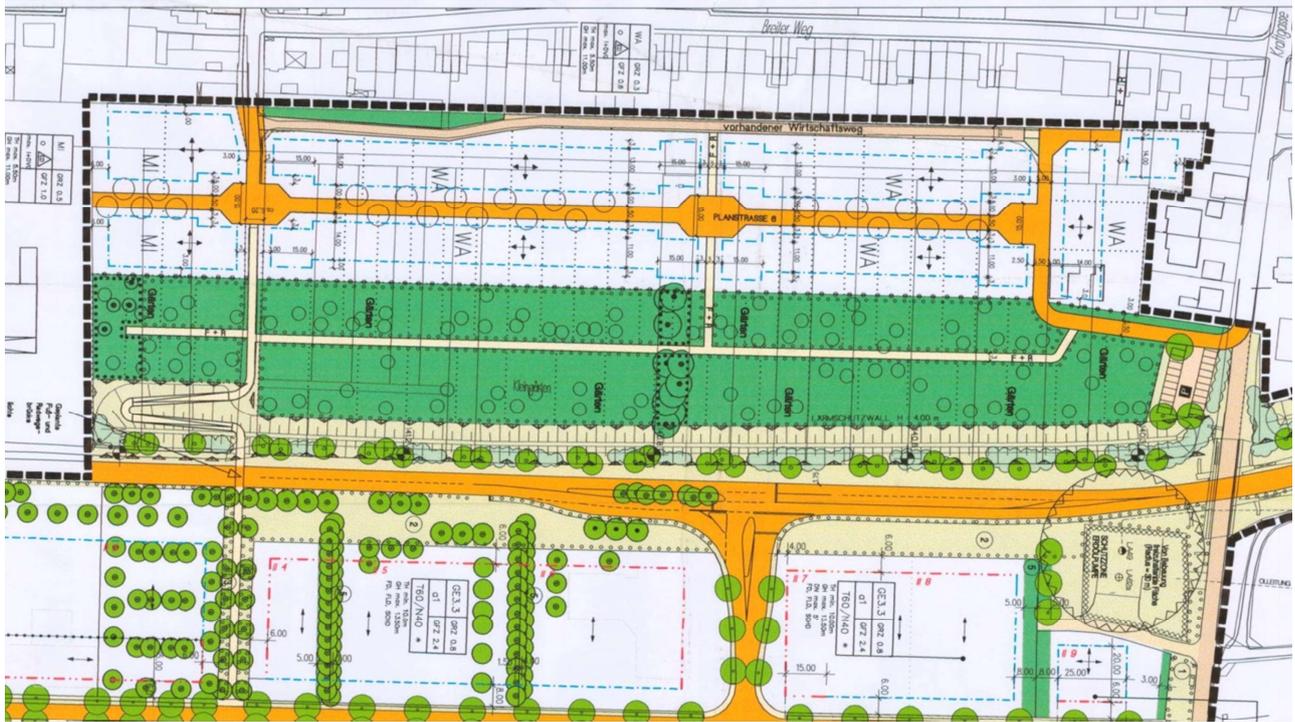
Teilausschnitt rechtskräftiger Bebauungsplan „D9-Änderung“; Stand: Juli 2006
